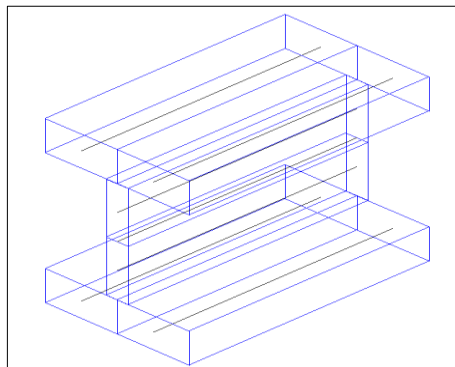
Exemplo de uma secção transversal tipo, HEB320.
